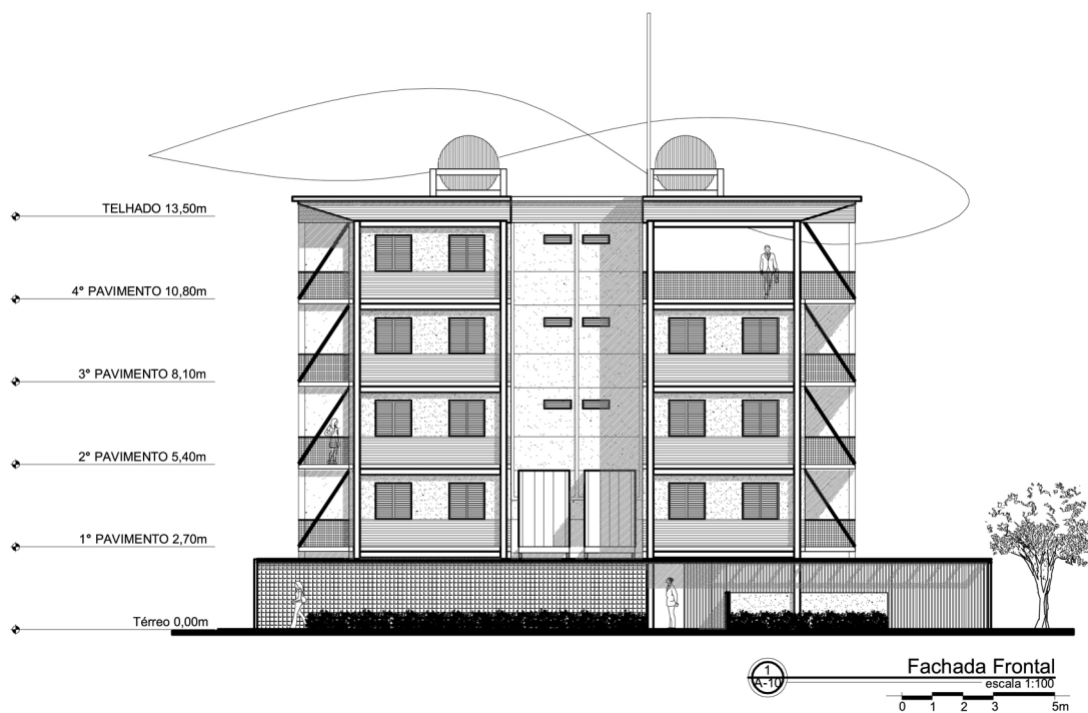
Fachada frontal. Fonte: Arquivo do autor
